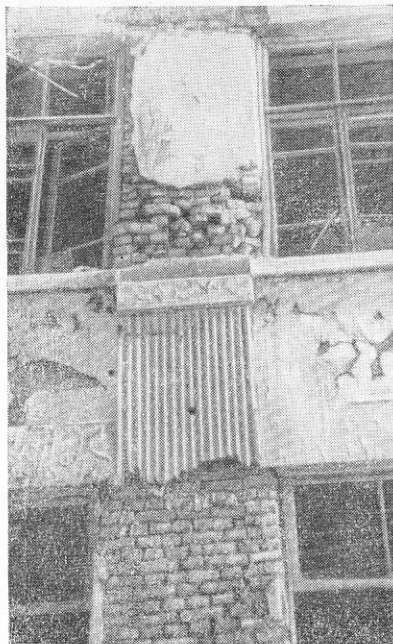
Разрушение узких простенков, нагруженных железобетонными балками перекрытий
